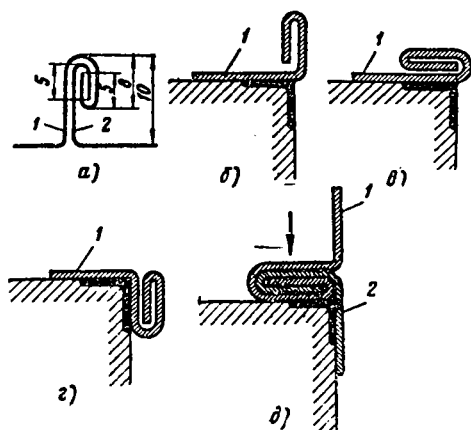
Изготовление двойного стоячего фальца ручным способом:
